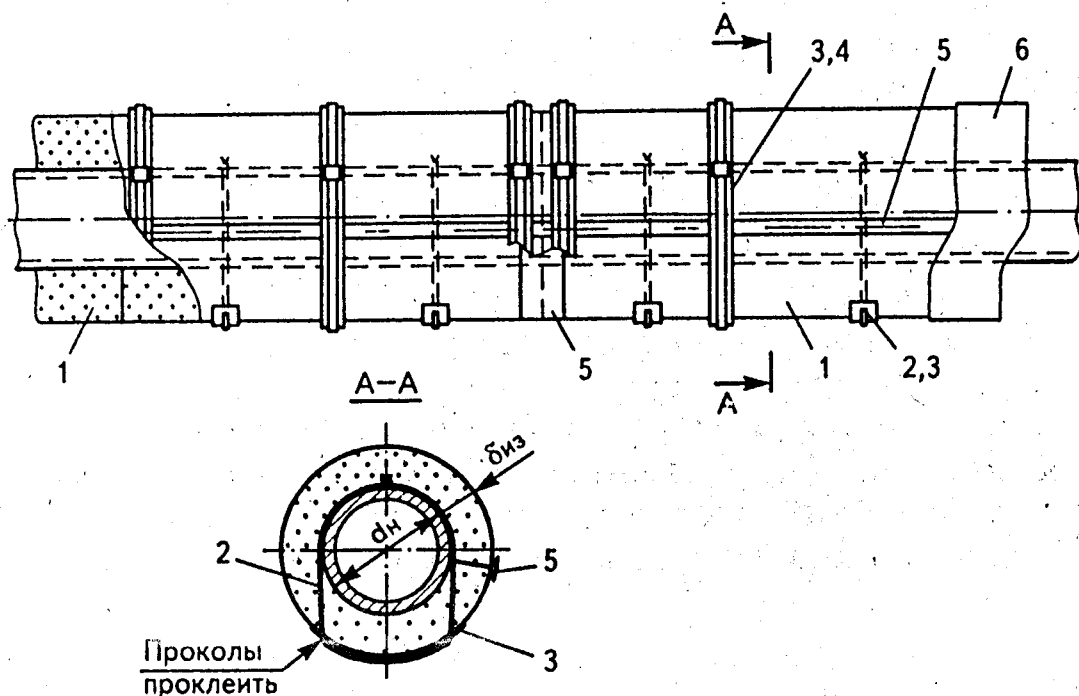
Изоляция трубопроводов или воздухопроводов круглого сечения матами теплоизоляционными, кашированными фольгой в один слой: 1 — мат теплоизоляционный; 2 — подвеска проволочная; 3 — прокладка; 4 — бандаж с пряжкой; 5 — проклейка швов лентой герметизирующей; 6 — защитное покрытие
